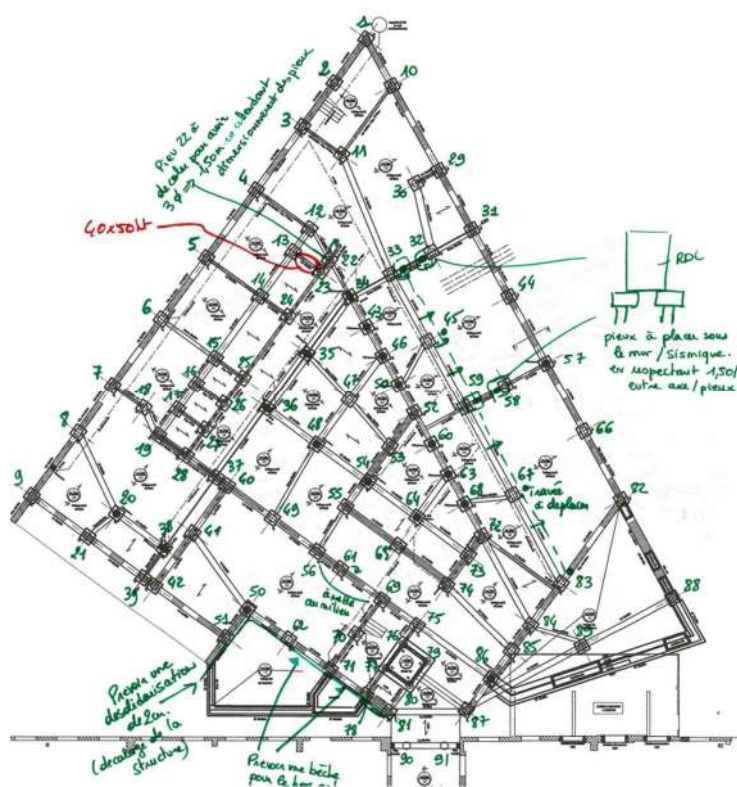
plan et tableaux récapitulatifs dimensions pieux
